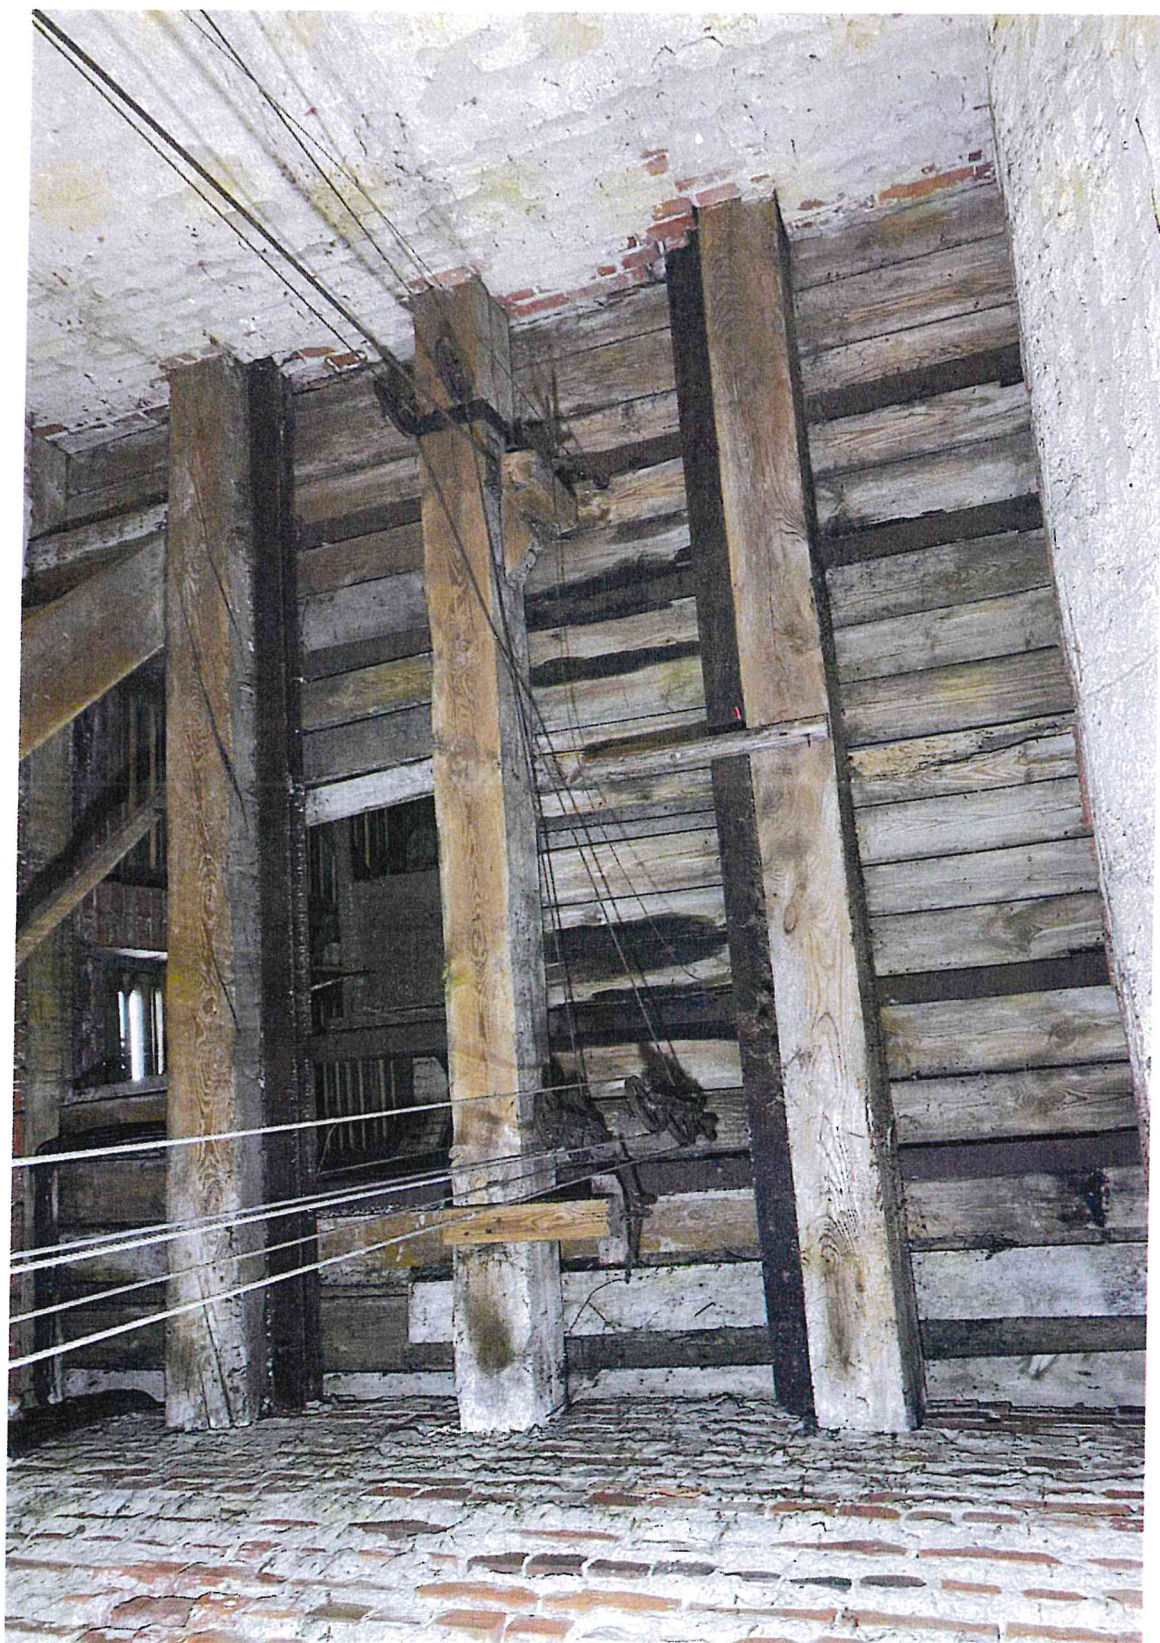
Kościół w Solcu – konstrukcja wieży, źródło: własne (sierpień 2023)
